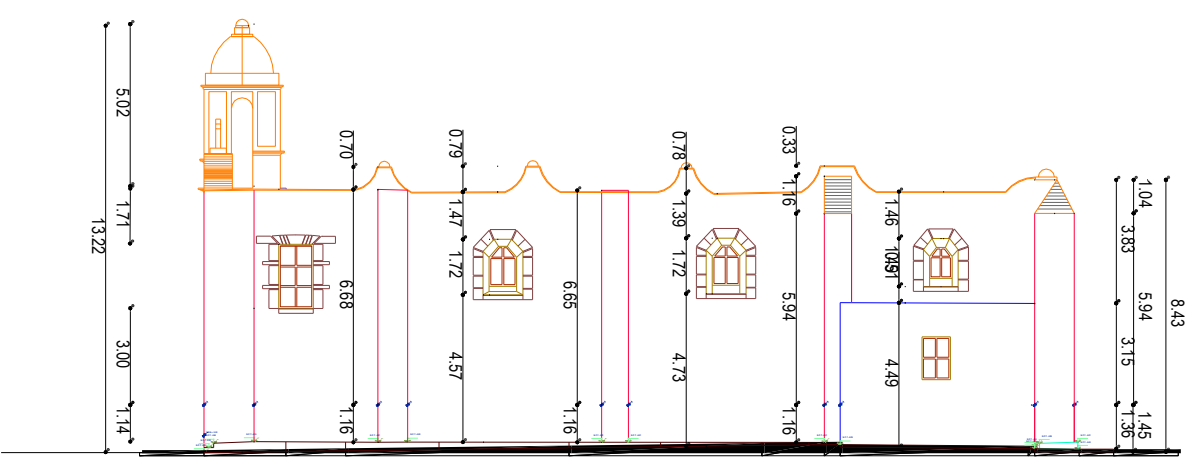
Esquema de plano arquitectónico 6 (Gutiérrez, 2011)
